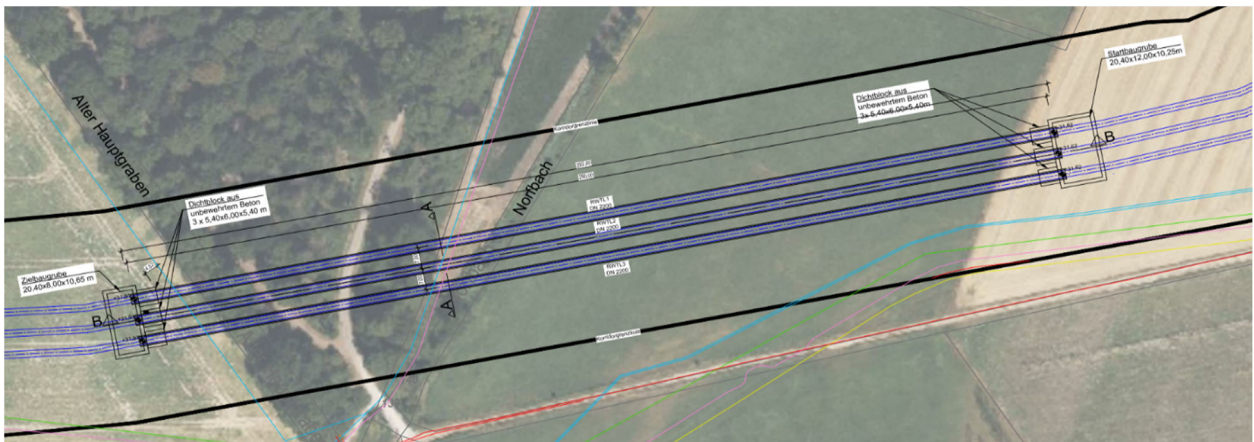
Knechtstedener Wald, Norfbach (Knechtstedener Graben) sowie Alter Hauptgraben, Lageplan, geschlossene Querung
